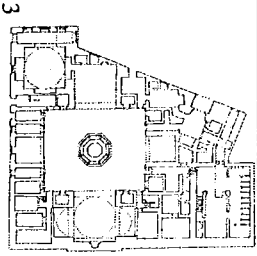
مسقط أفقي مدرسة السلطان حسن
